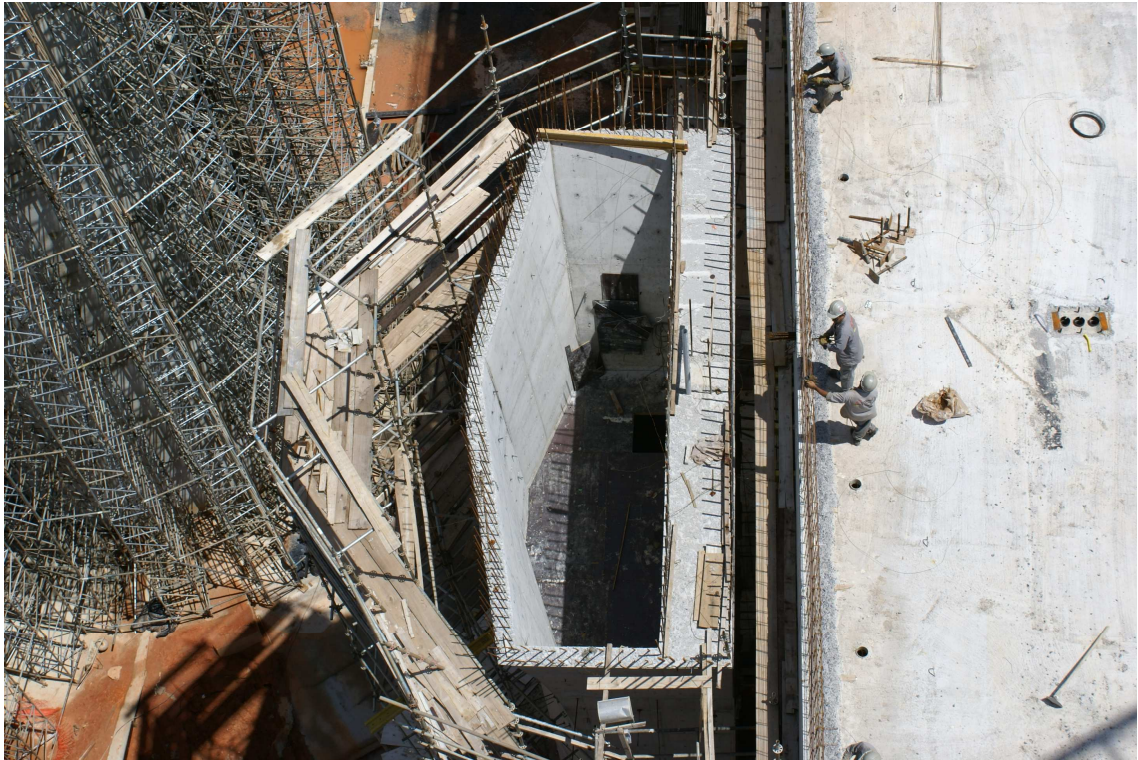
Pilares Pórtico - 7ª Etapa – Detalhe Armação e Vista Interna do Pilar
